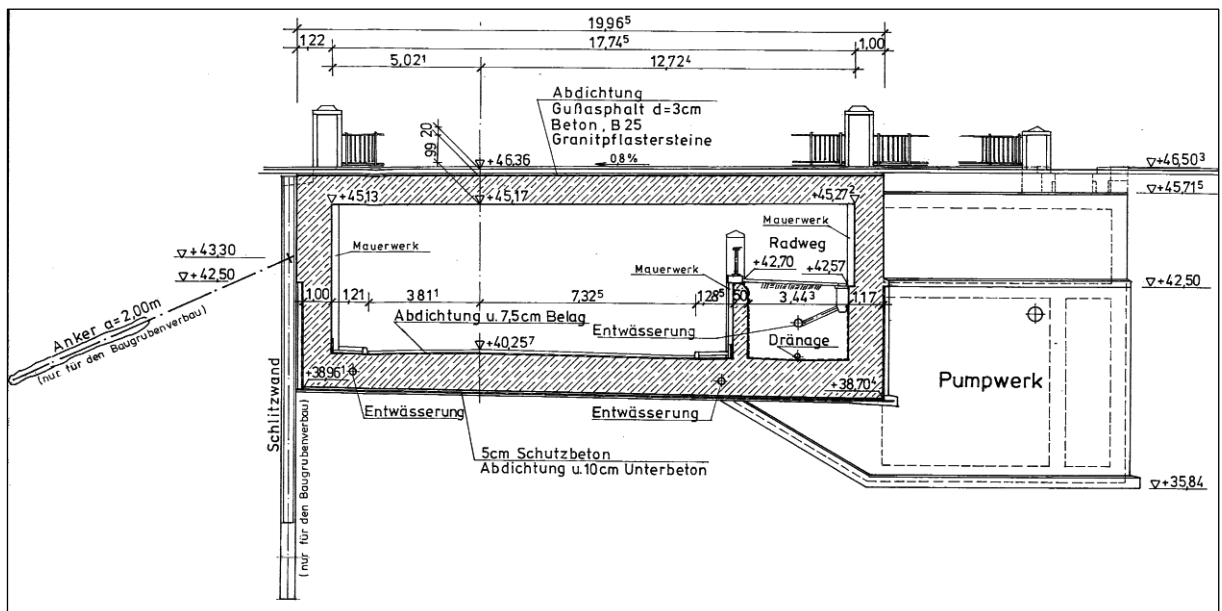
Schnitt H-H (Brücke Hagener Alle) – Segment 4
